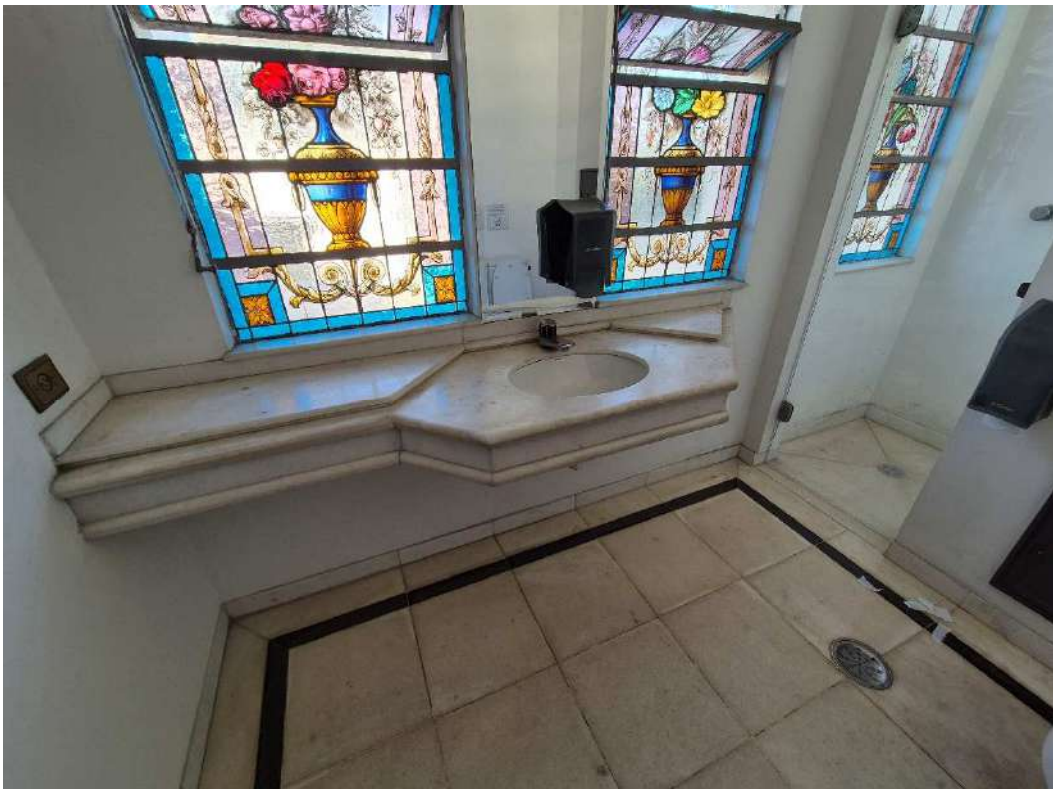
Aspecto interno da edificação principal (Pavimento Superior).
